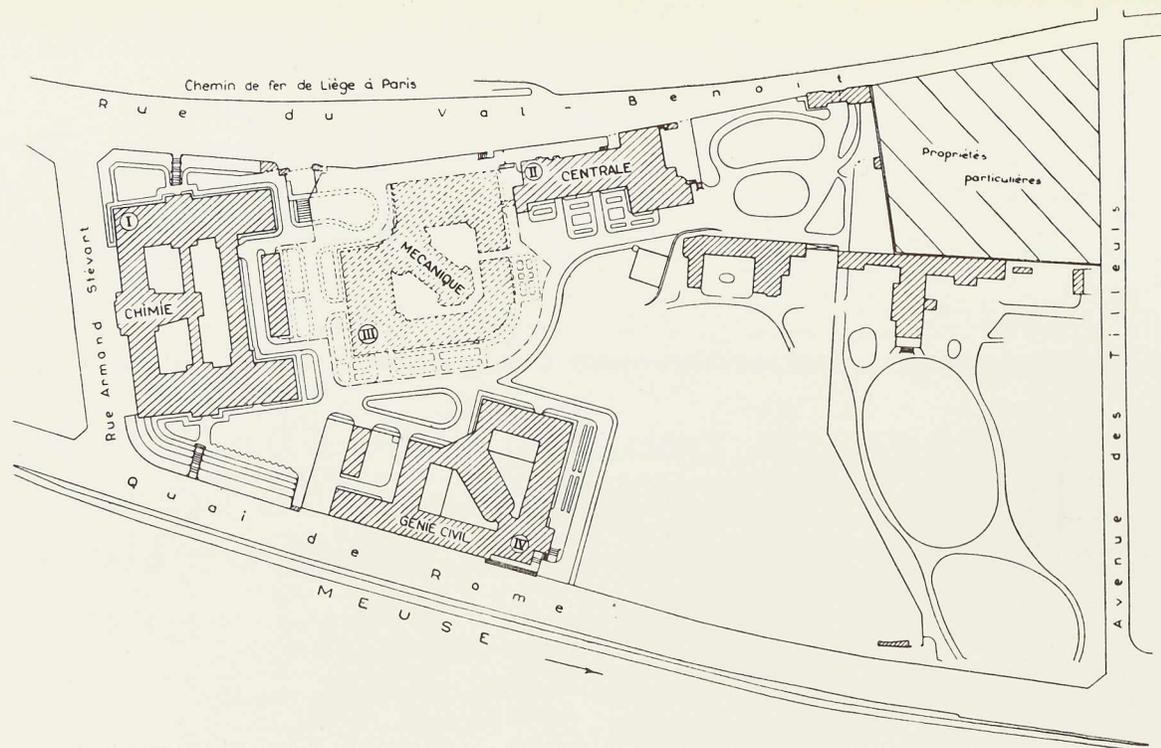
Plan général de situation des nouveaux bâtiments universitaires du Val-Benoît à Liège.
